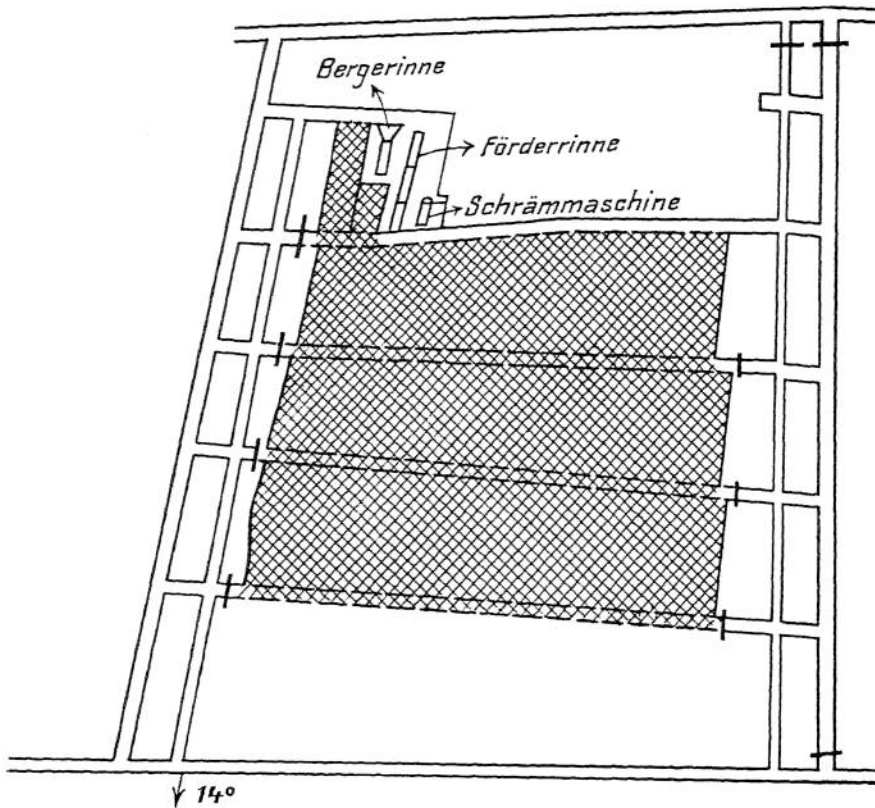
Streichender Pfeilerbau mit Bergeversatz und Schrämbetrieb.
